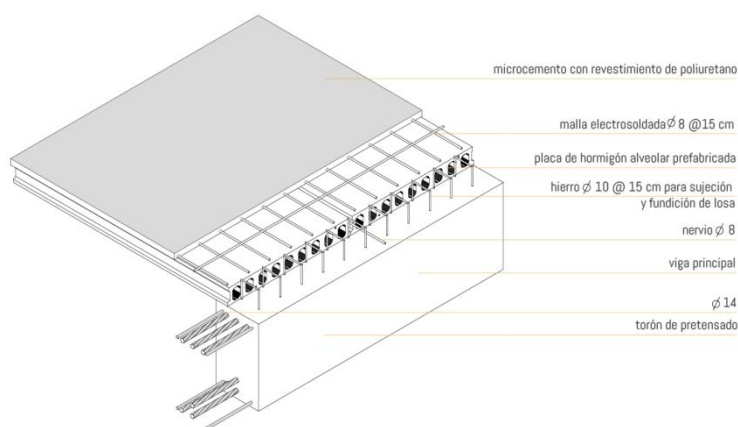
Despiece de piso de hormigón. Fuente: elaboración propia
